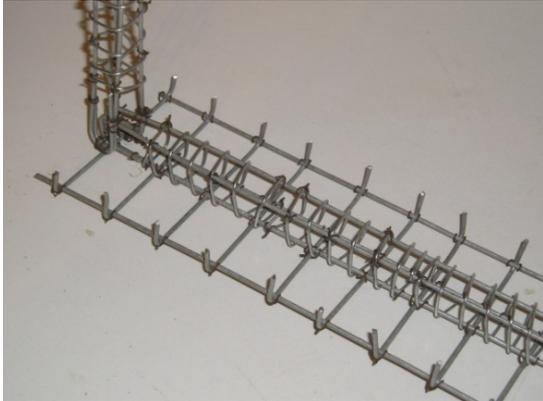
Encadenado inferior dentro de una plantilla de fundación.
